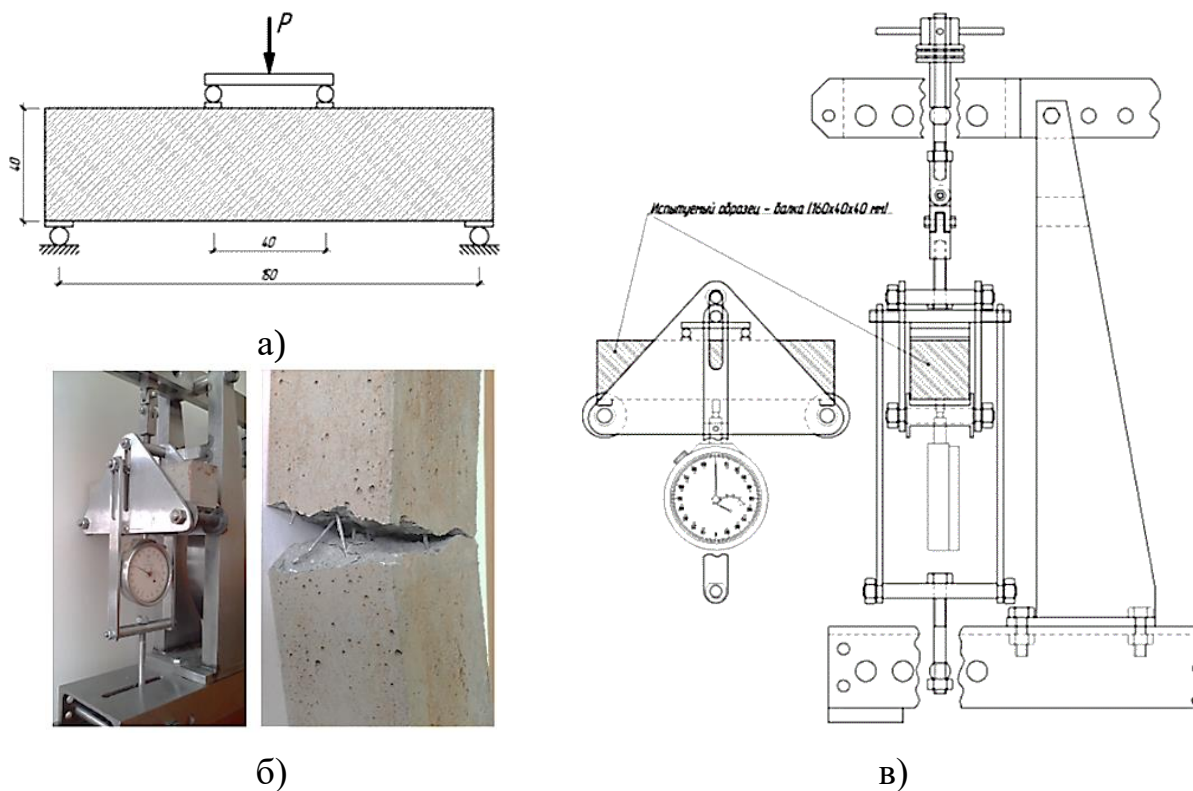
Крепление балки 160x40x40 мм при испытании на изгиб: а – схема закрепления балки в захватах, б – фотоиллюстрация крепления балки, в – схема нагружения балки
